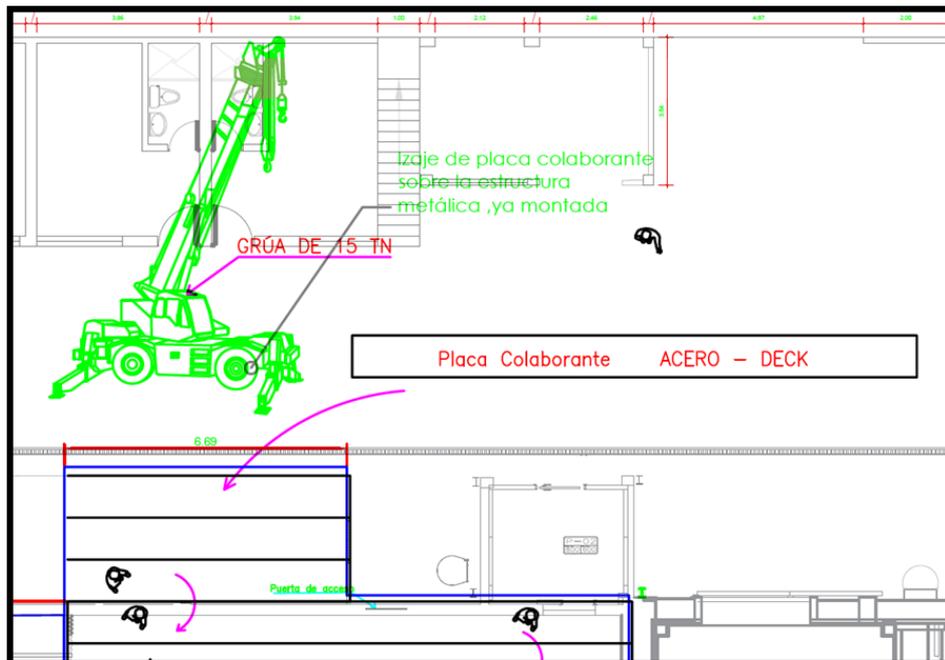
Layout de Montaje de estructura metálica 1er nivel
